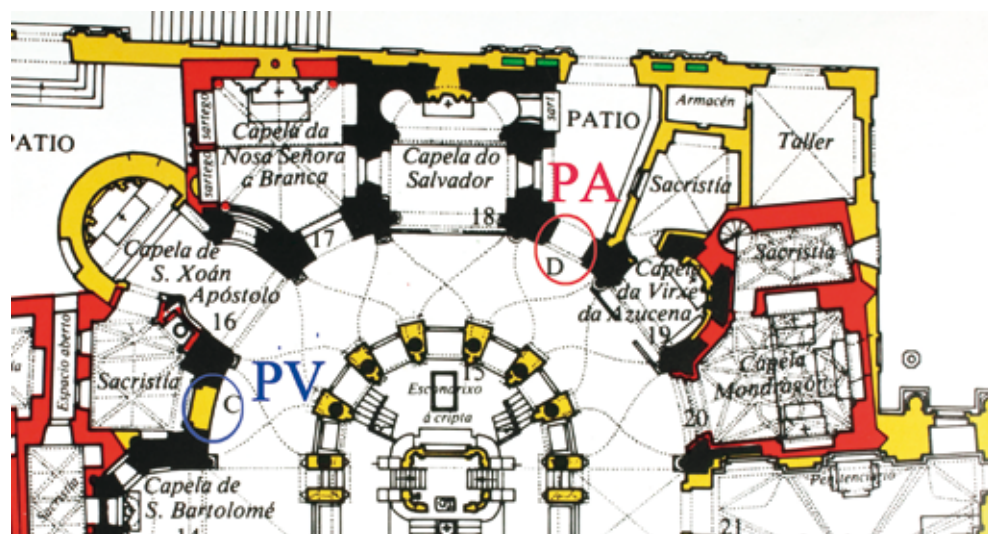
Detalle de *The Cathedral Church of Santiago... Plan of the principal level*.
